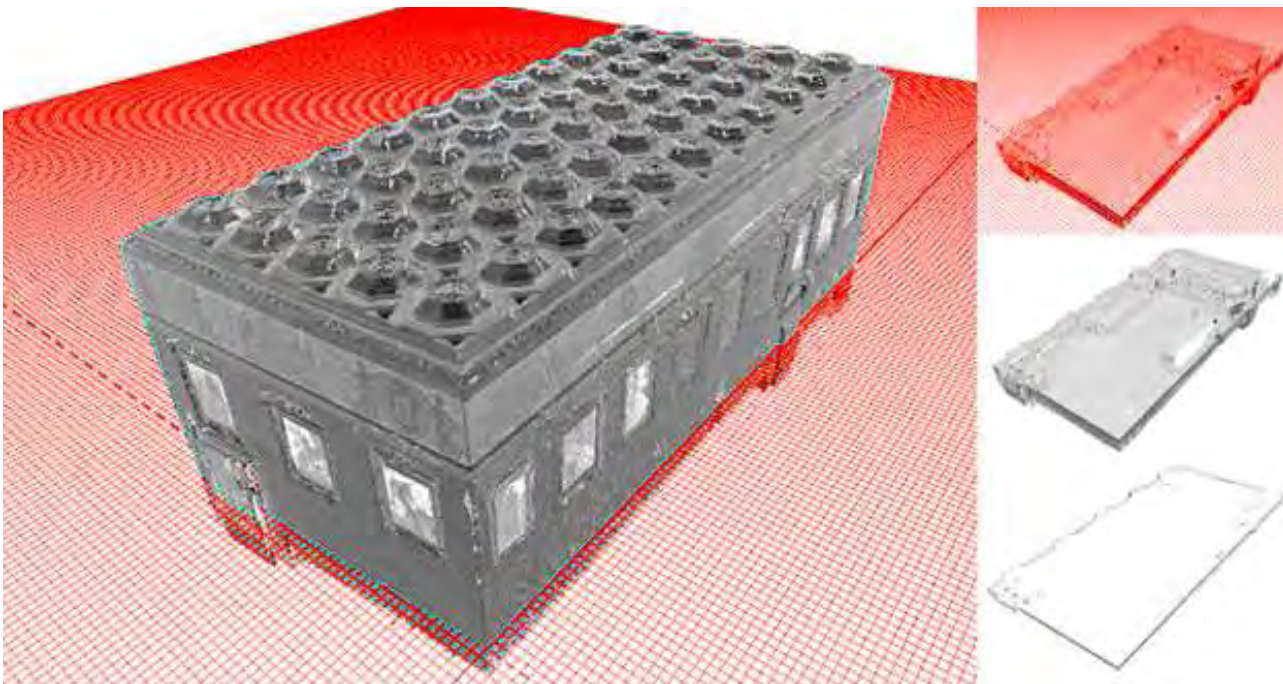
Estrazione di un profilo sezione orizzontale dal modello complessivo di punti. A sinistra, modello di punti con piano sezione orizzontale; a destra, dall'alto, dal modello sezionato in corrispondenza del piano al profilo sezione (Sala Consiliare, Prato, rilievo GeCo, 2010)
